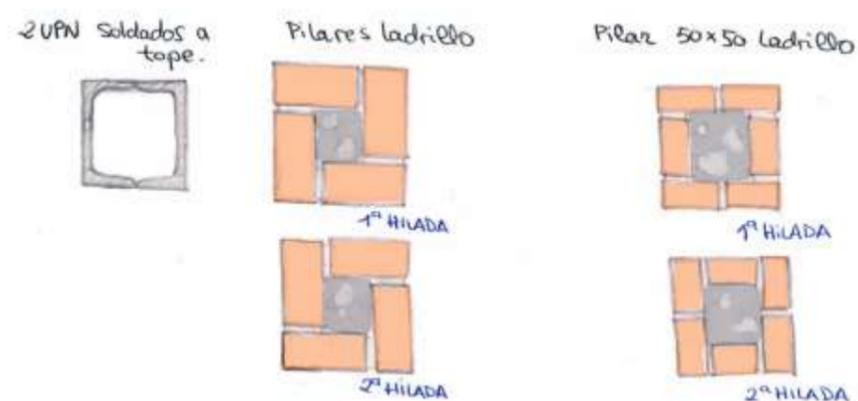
Detalles de las diferentes tipologías de pilares. Elaboración propia.
